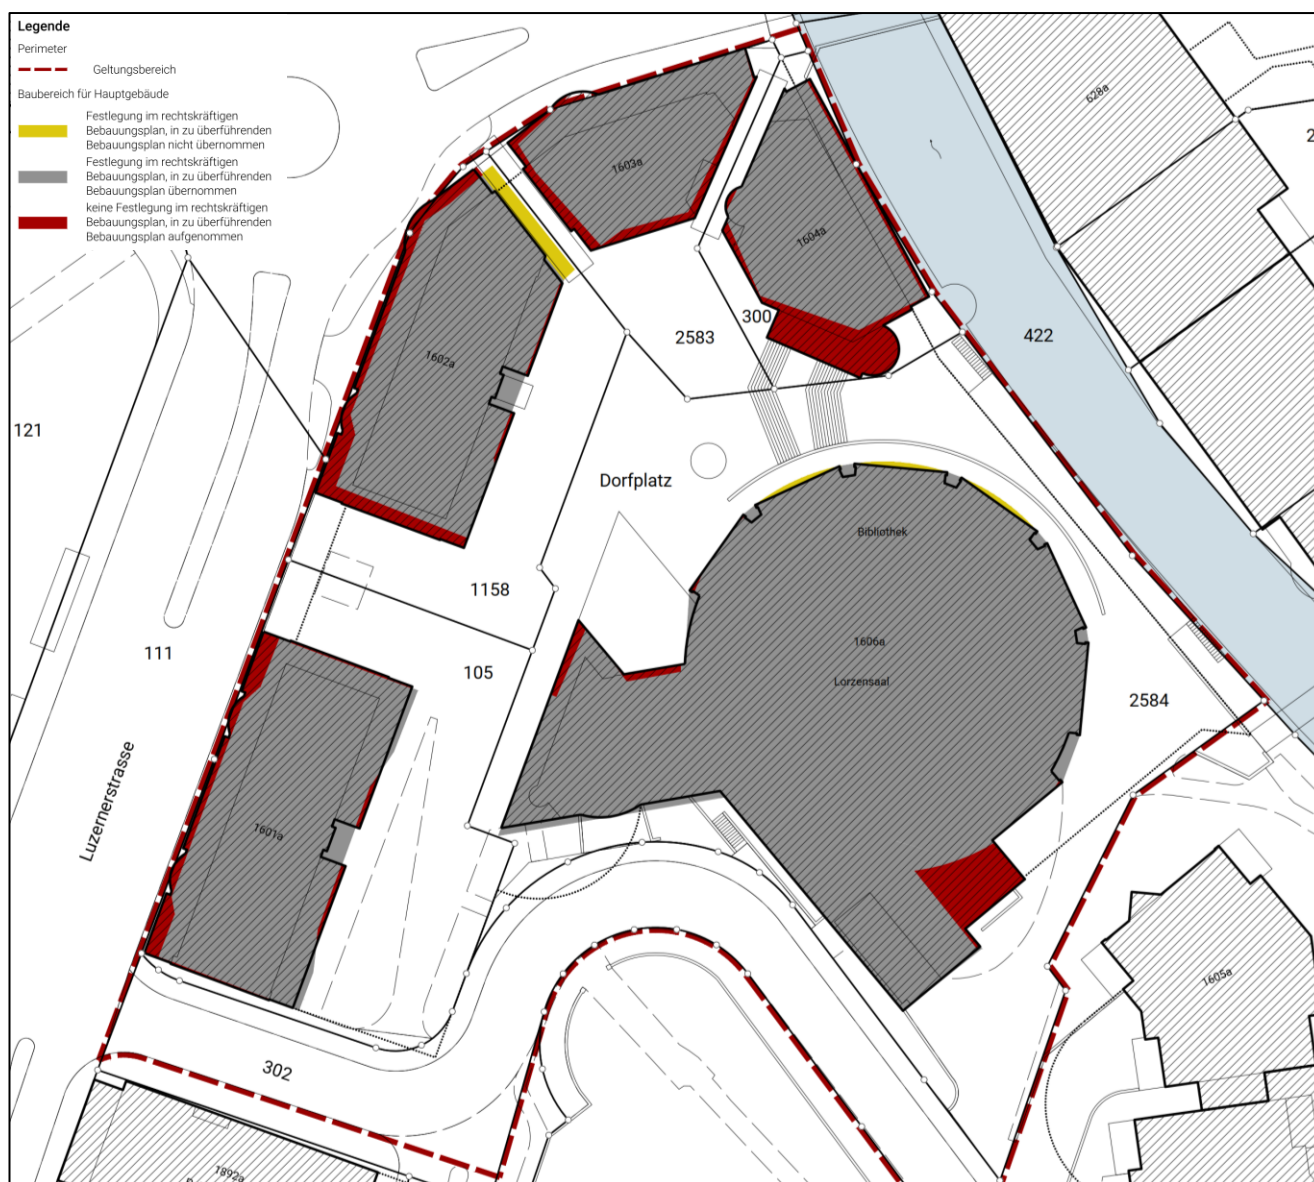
Differenzplan Dimensionierung der Baubereiche für Hauptgebäude. Vergleich rechtskräftiger und überführter Bebauungsplan
